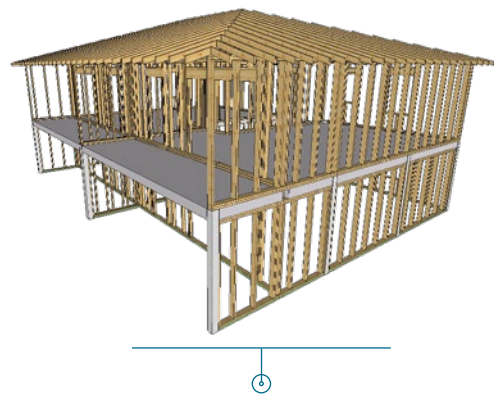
OSSATURE BOIS EN PAROIS VERTICALES ET DALLE BÉTON
